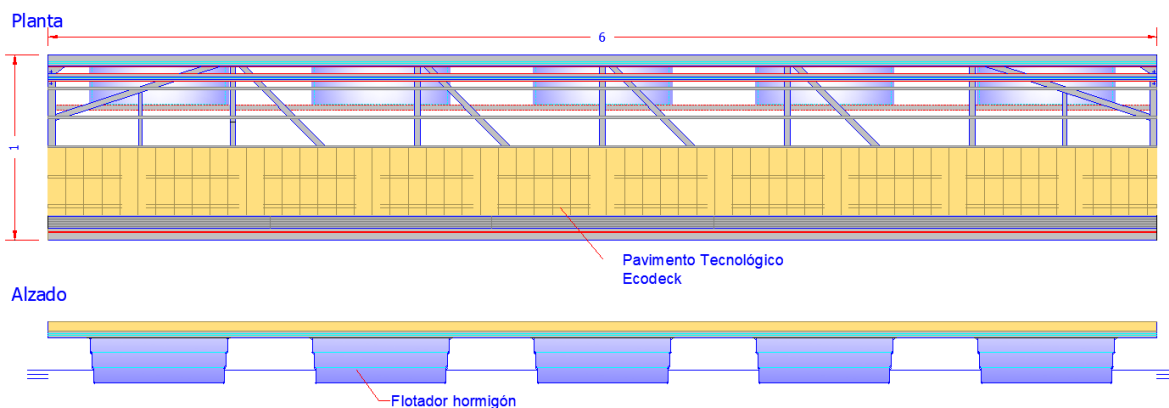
Detalle de planta y alzado del pantalán flotante 1.0 m ASE-900.
